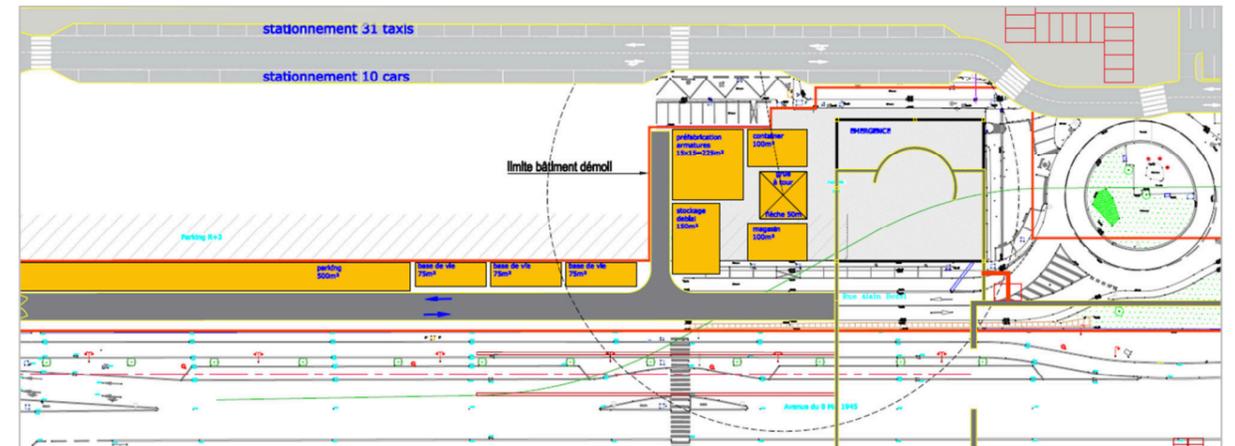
Plan d'installations de chantier avec reprise du trafic sur l'ex-RN2
